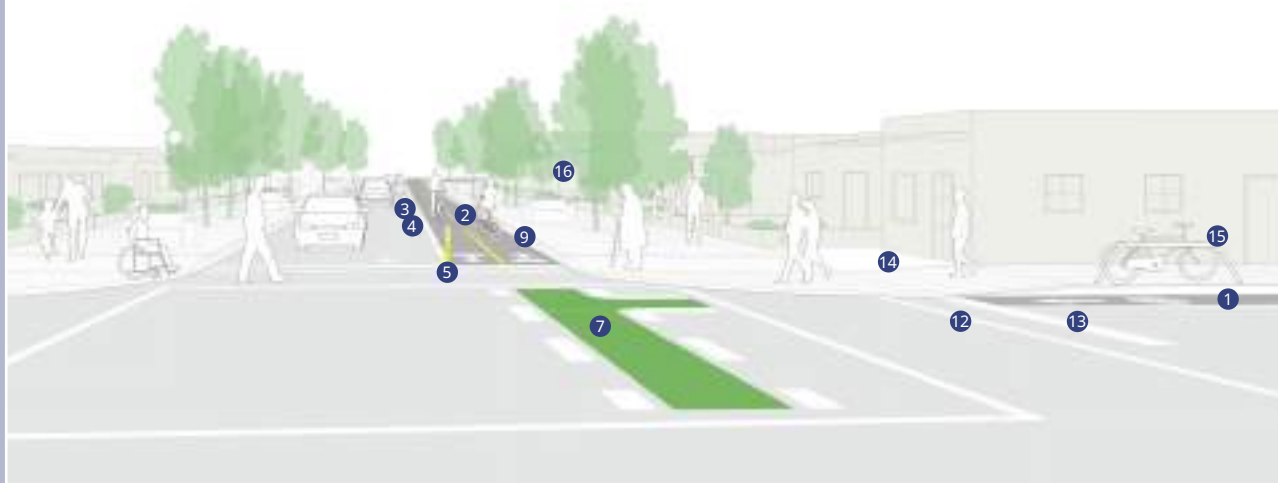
Planta de intersección con ciclovia en T - Trinidad
